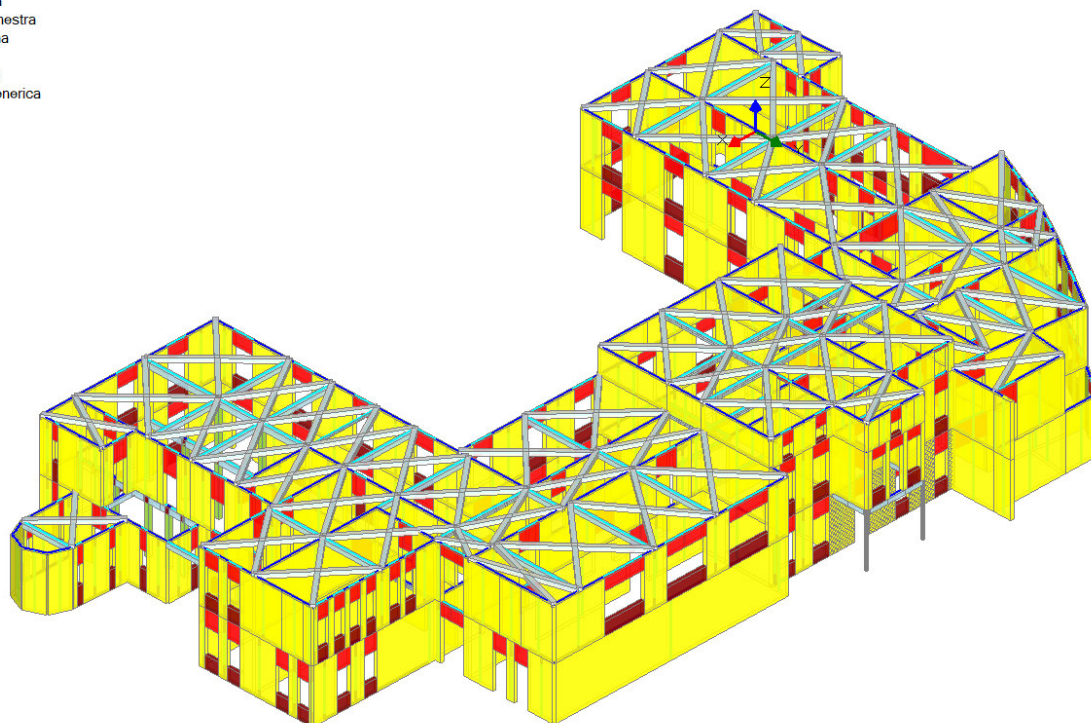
Elementi strutturali collegati alle aste del telaio equivalente di Fig. 6-14
